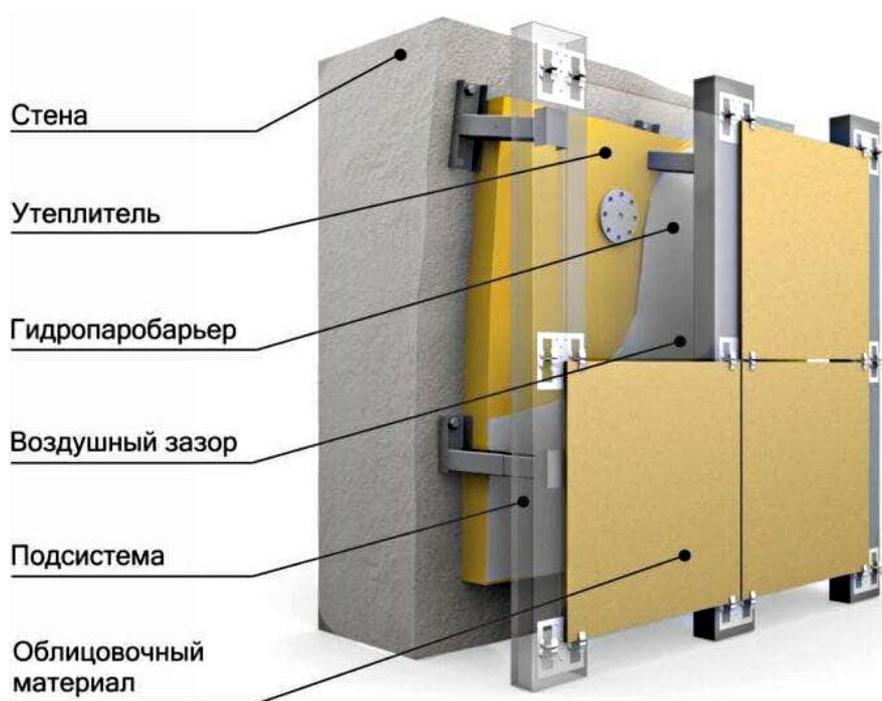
Конструкция навесного вентилируемого фасада (НВФ) здания
